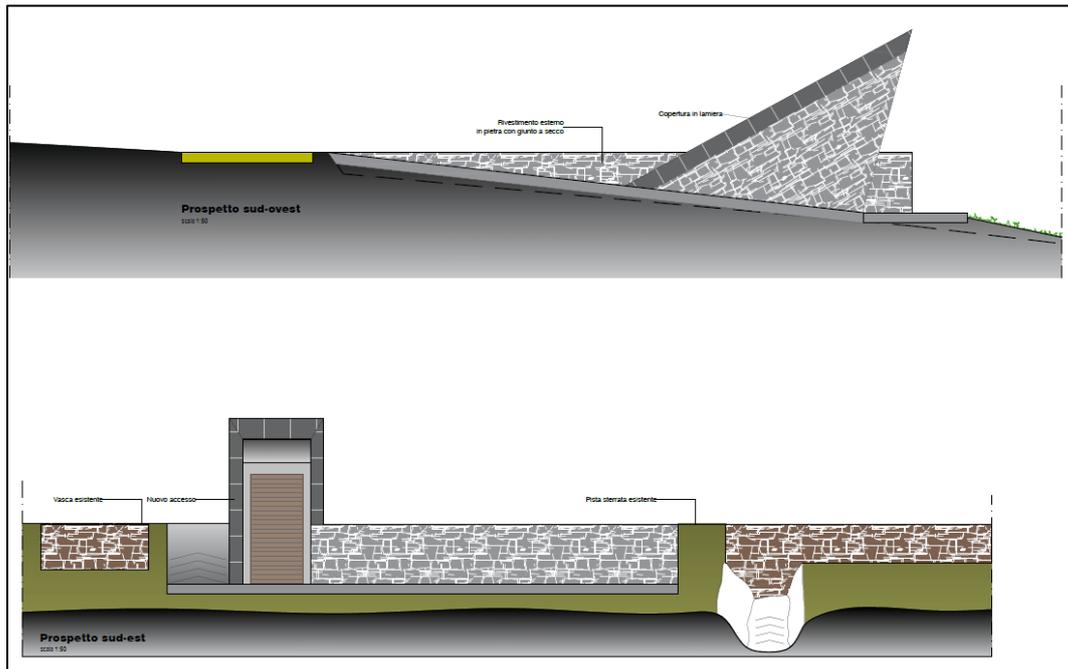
Prospetto Su-Ovest e Prospetto Sud_Est estratti da Tav D4.03
